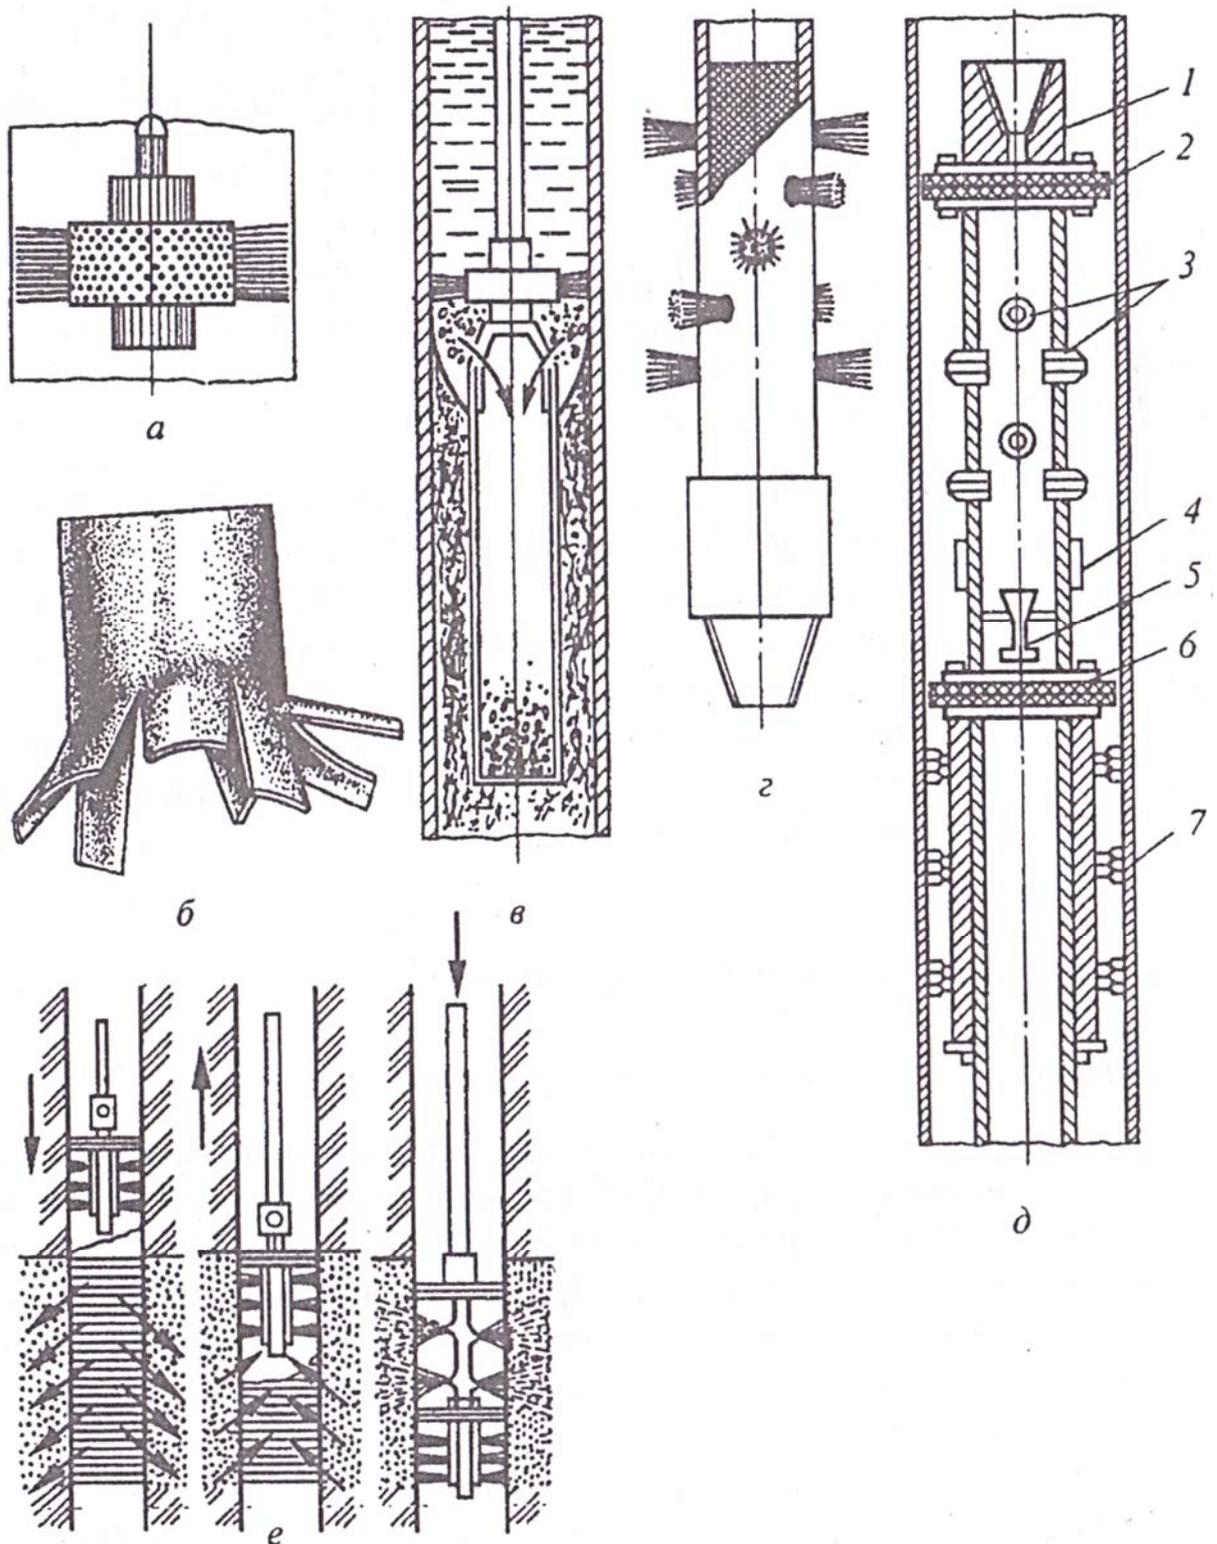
Приспособления для очистки фильтров скважин от отложений:
